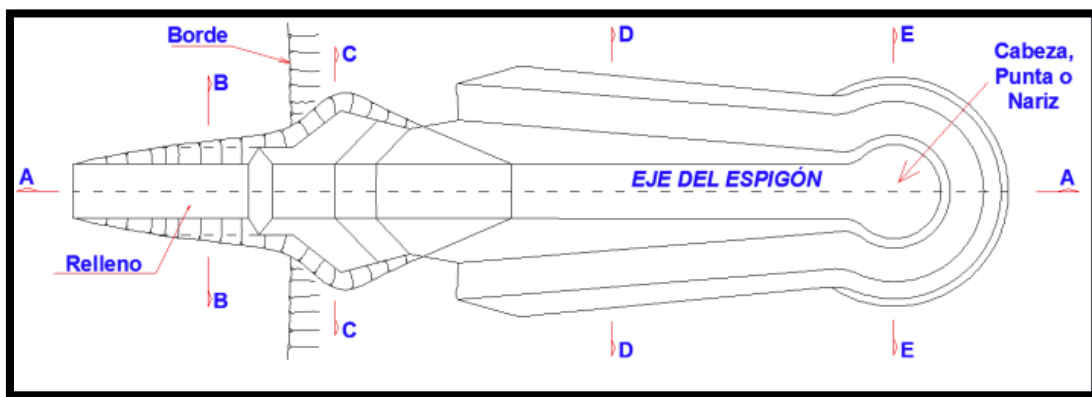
Vista en planta de la sección típica de un espigón, proyecto río tumbes.
